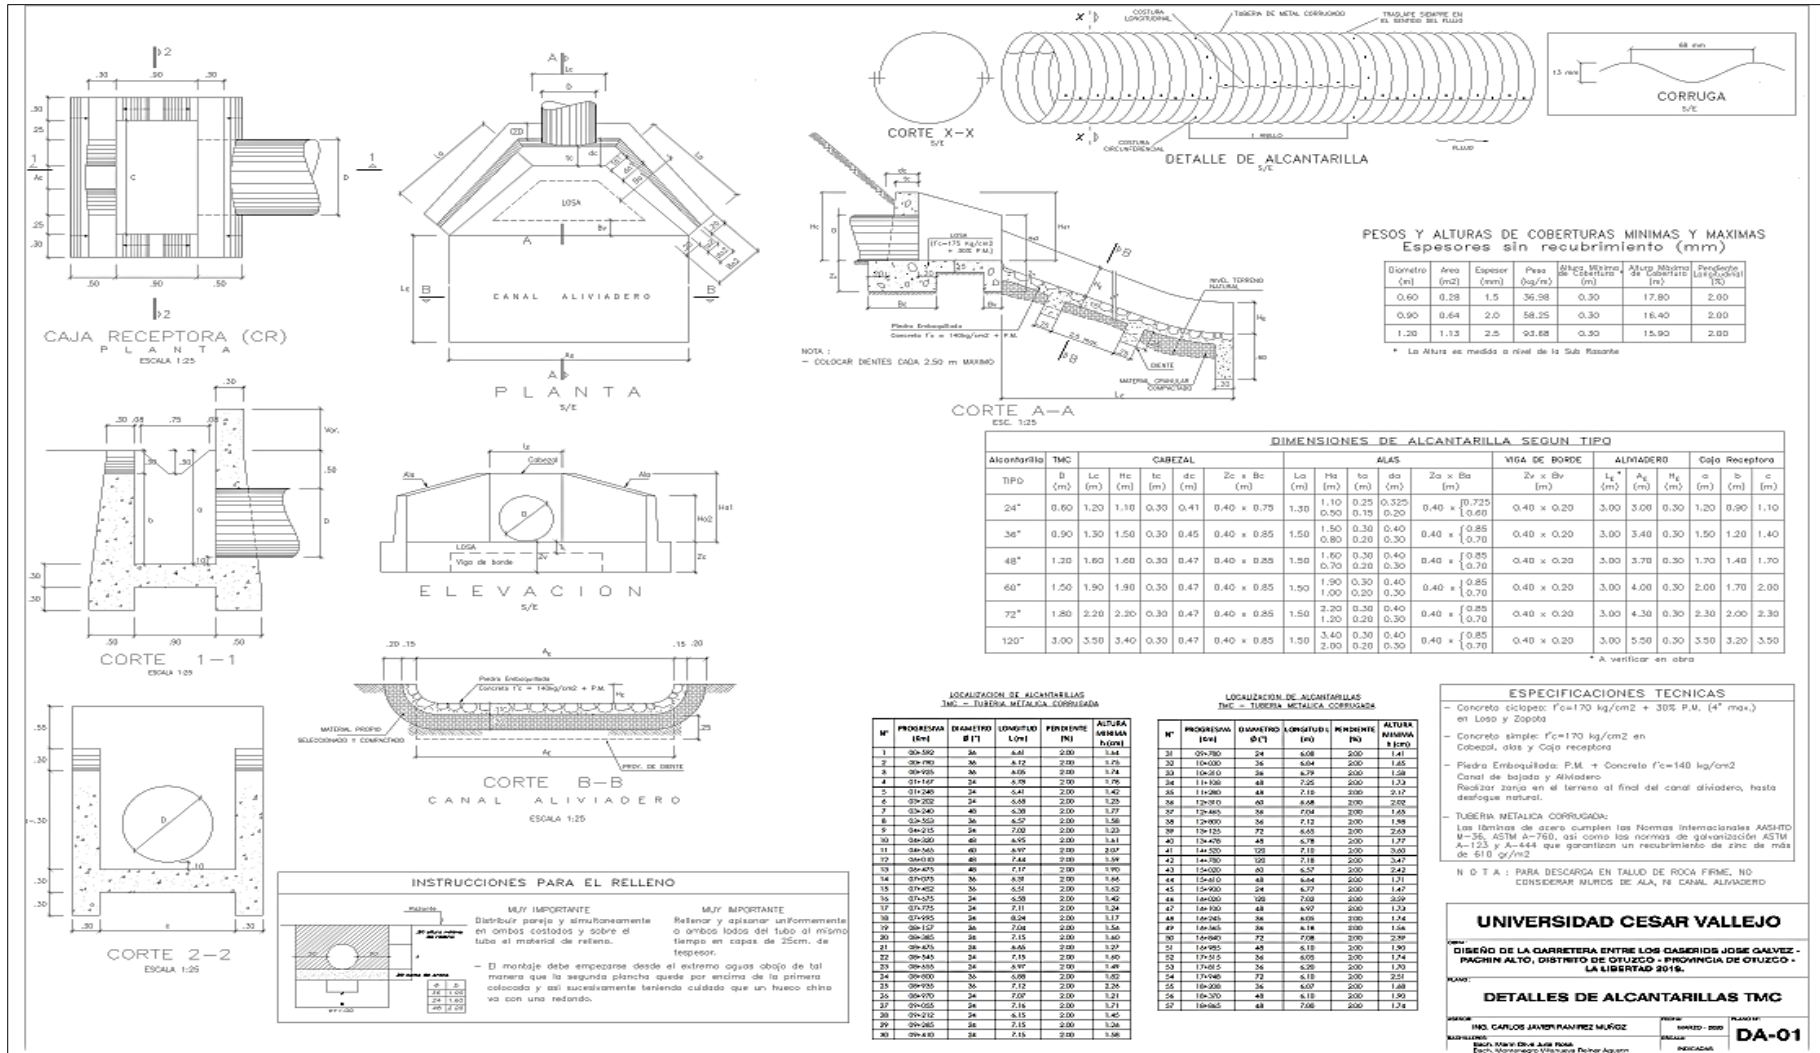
Detalle del diseño hidráulico de la alcantarilla tipo TMC. Fuente: Elaboración propia.
